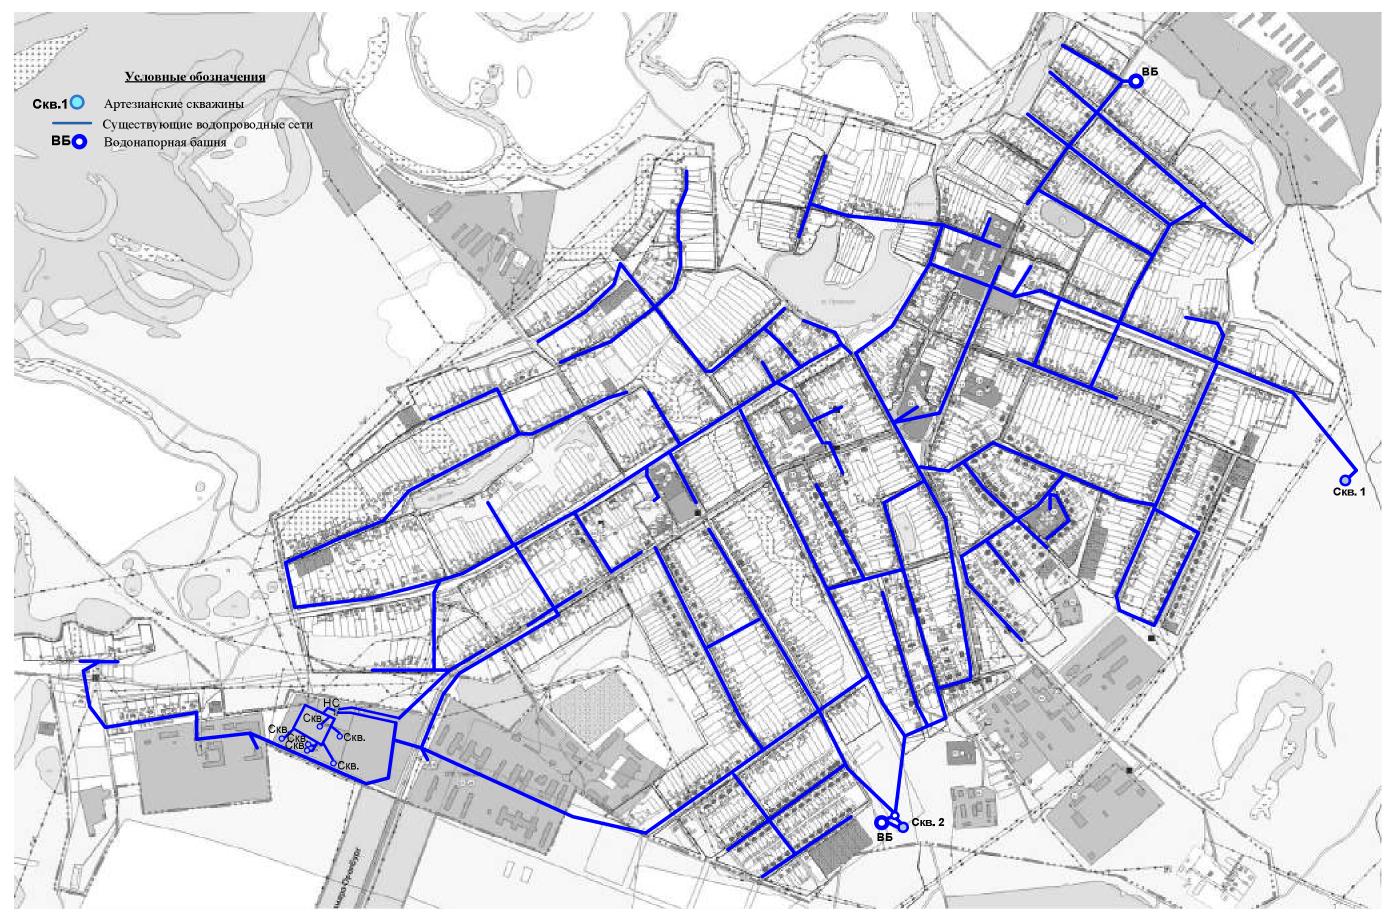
План водопроводных сетей с. Утёвка
